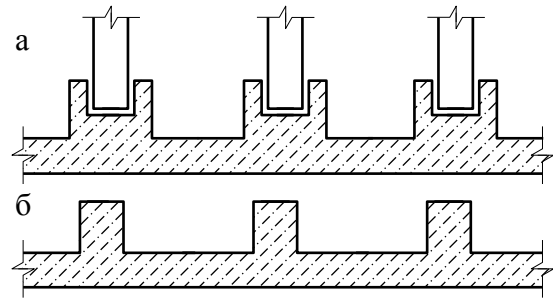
Суцільні фундаменти у вигляді: а – плоскої плити; б – ребристої плити
